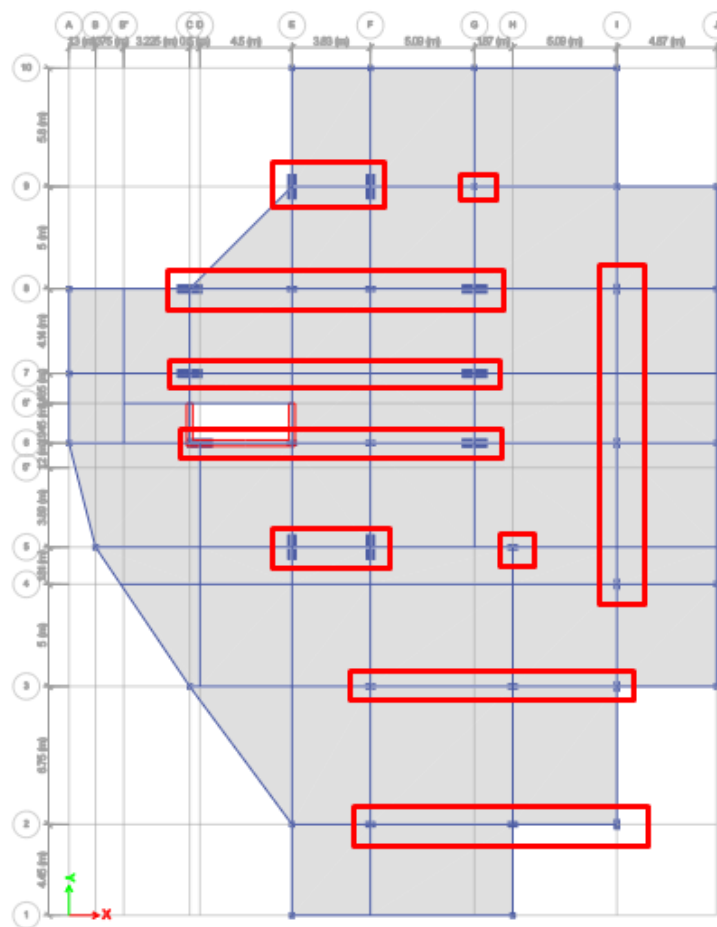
Localización de Columnas dispuestas en la Planta #1, #2 y #3 para ensayo de esclerometría
